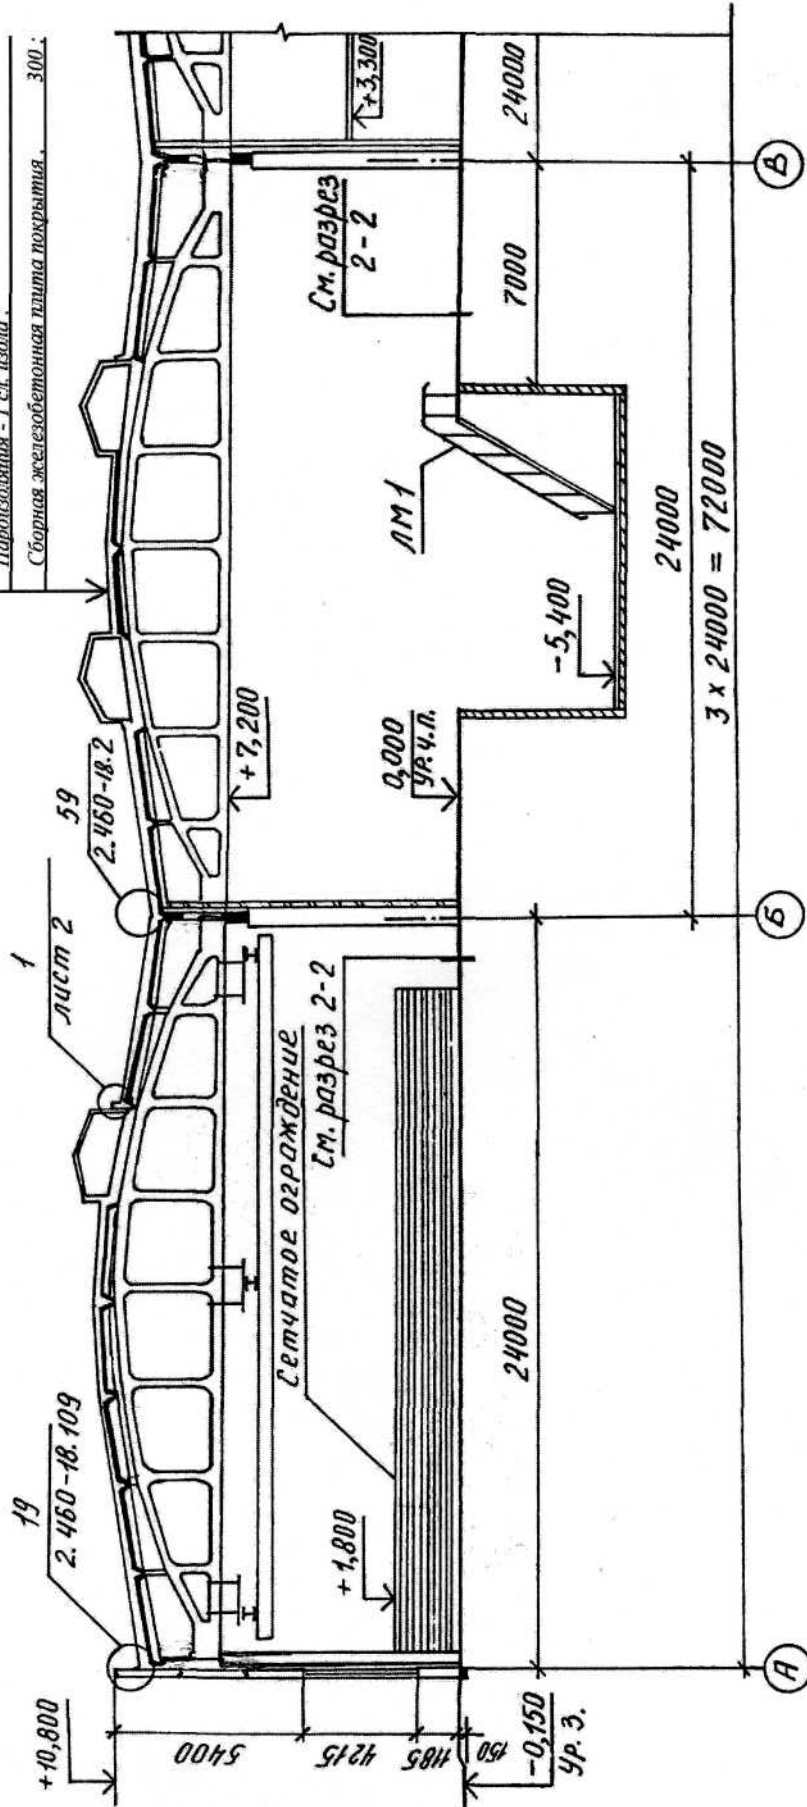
Пример выполнения поперечного разреза промышленного здания с зенитными фонарями
